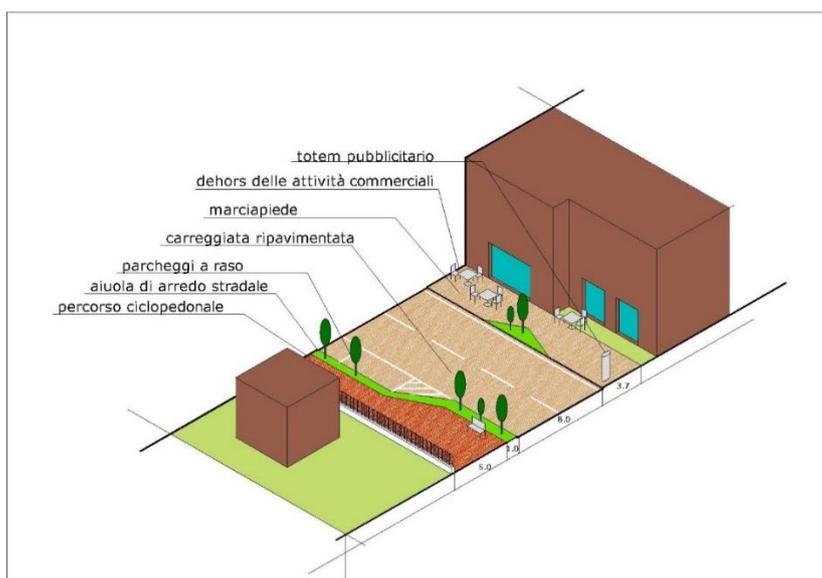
Rappresentazione schematica stato di progetto sezione 1
